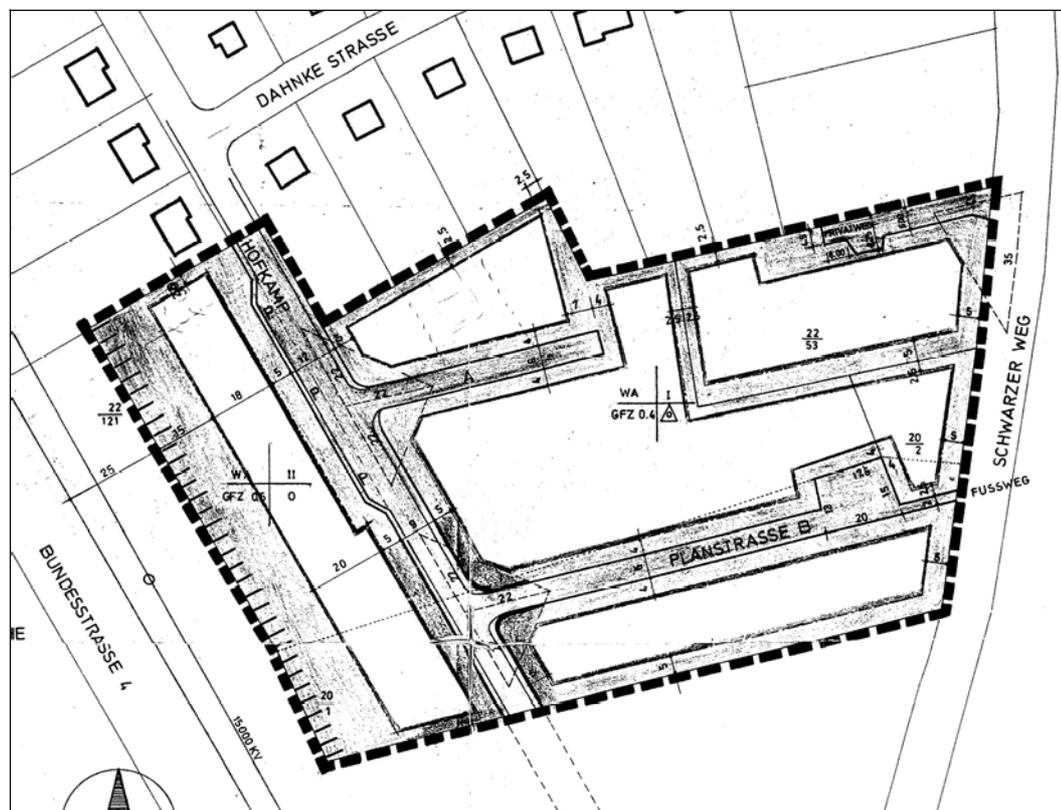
Bebauungsplan 1A "Erweiterung Hofkamp" aus dem Jahre 1960
